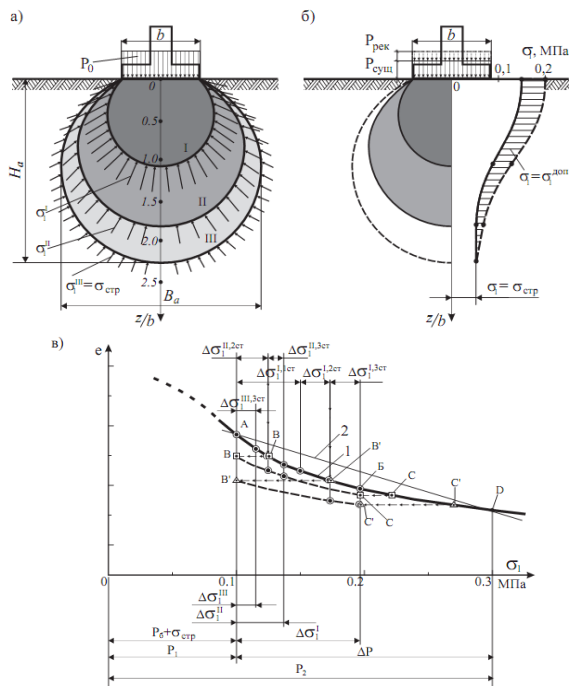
Расчетная схема предлагаемого метода определения осадок основания фундамента:
